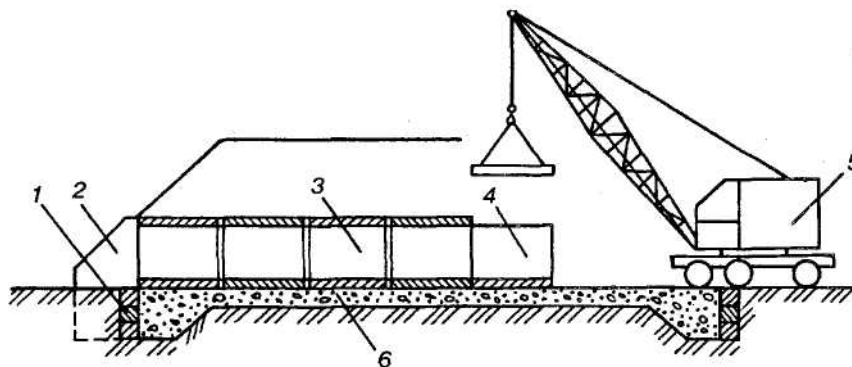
Монтаж прямоугольной трубы из плитных элементов:
